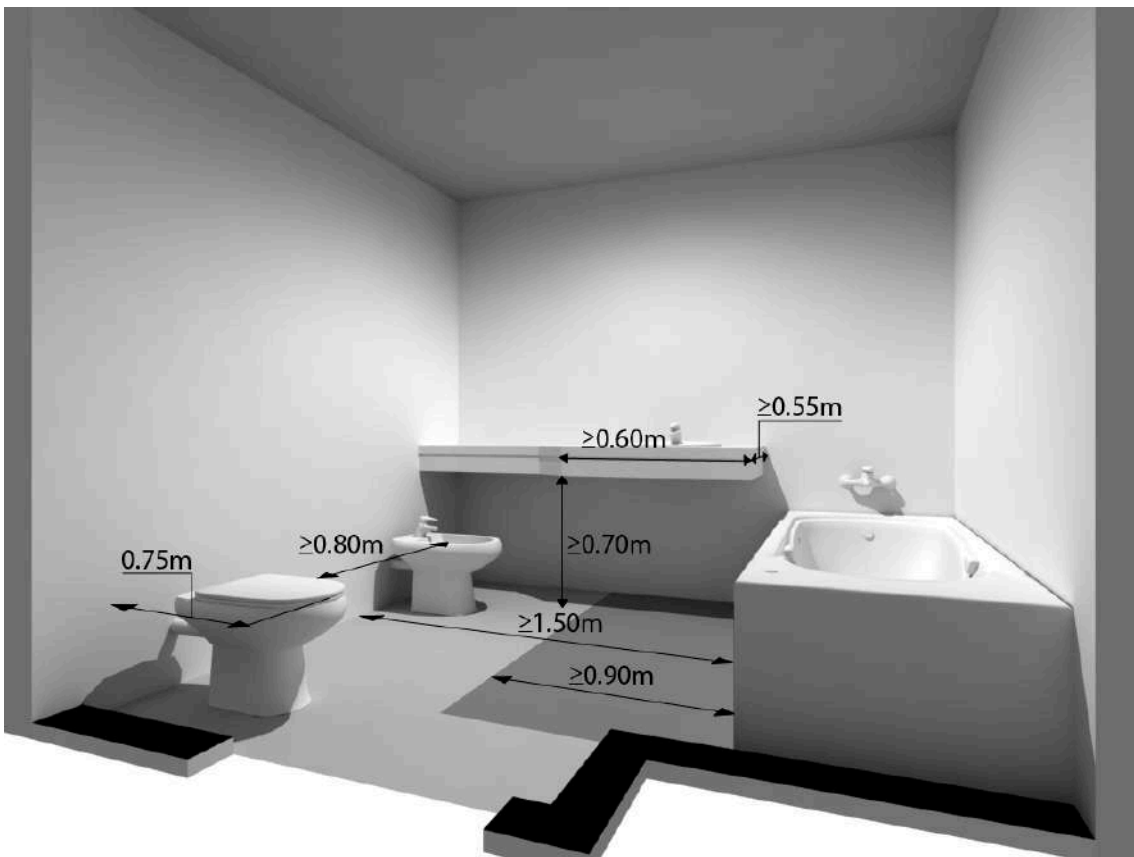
Nível 2: características do equipamento da instalação sanitária acessível
